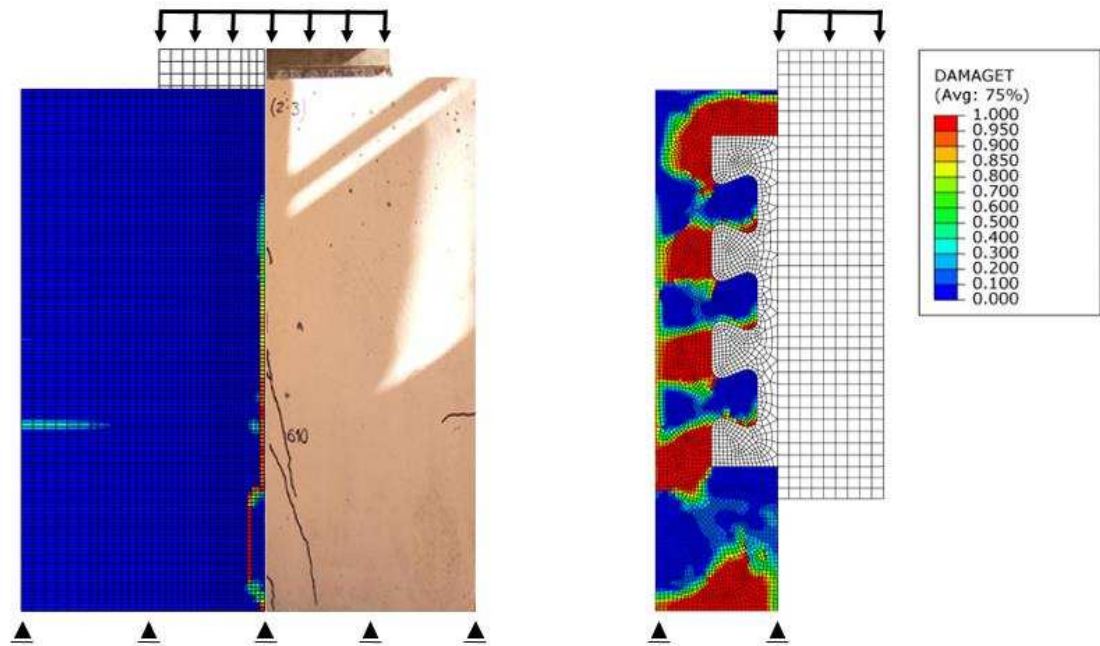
Primeira fissura aparente na laje de concreto: (a) no experimento e (b) no modelo numérico C1-C2.
